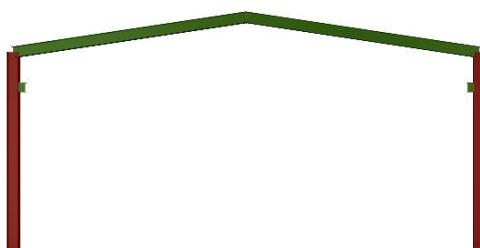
Pórtico interior (Alineación D, E, F, G, H, I)
